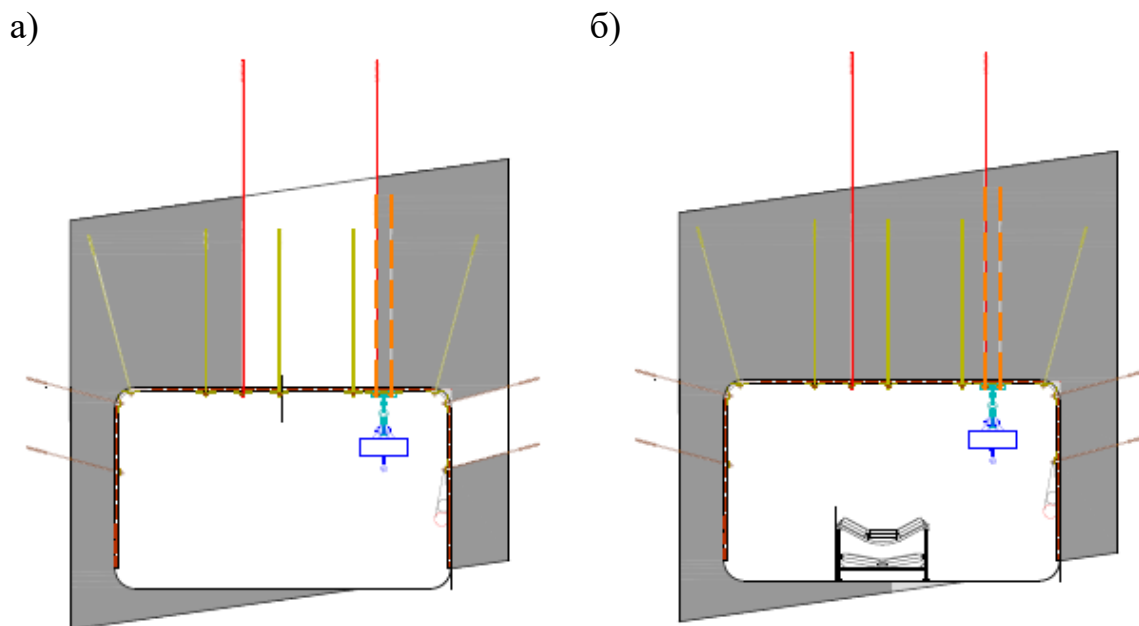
Потери в выпускаемом слое подкровельной пачки угля на сопряжениях с вентиляционным (а) и конвейерным (б) штреками.
